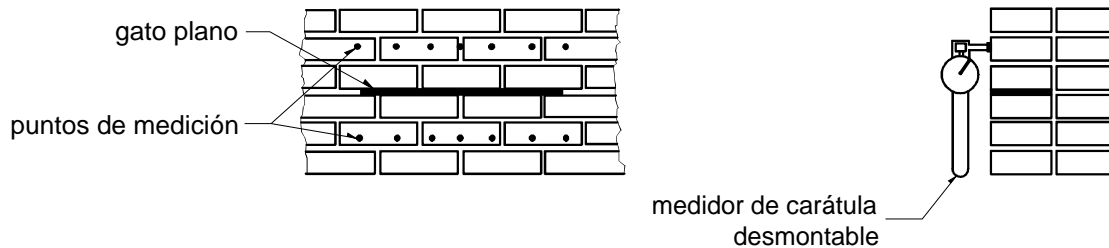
Dispositivo de prueba para la determinación in situ del estado de esfuerzos de compresión existente dentro de la mampostería
